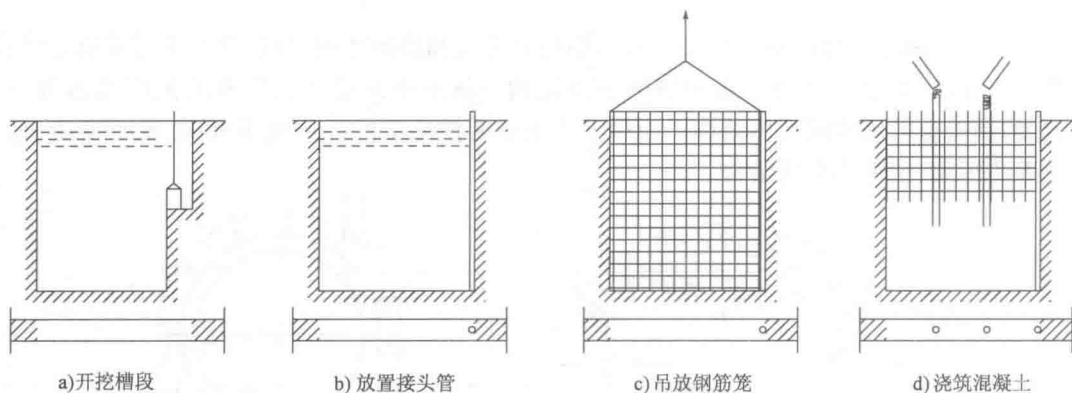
地下连续墙墙体结构施工过程的示意图
